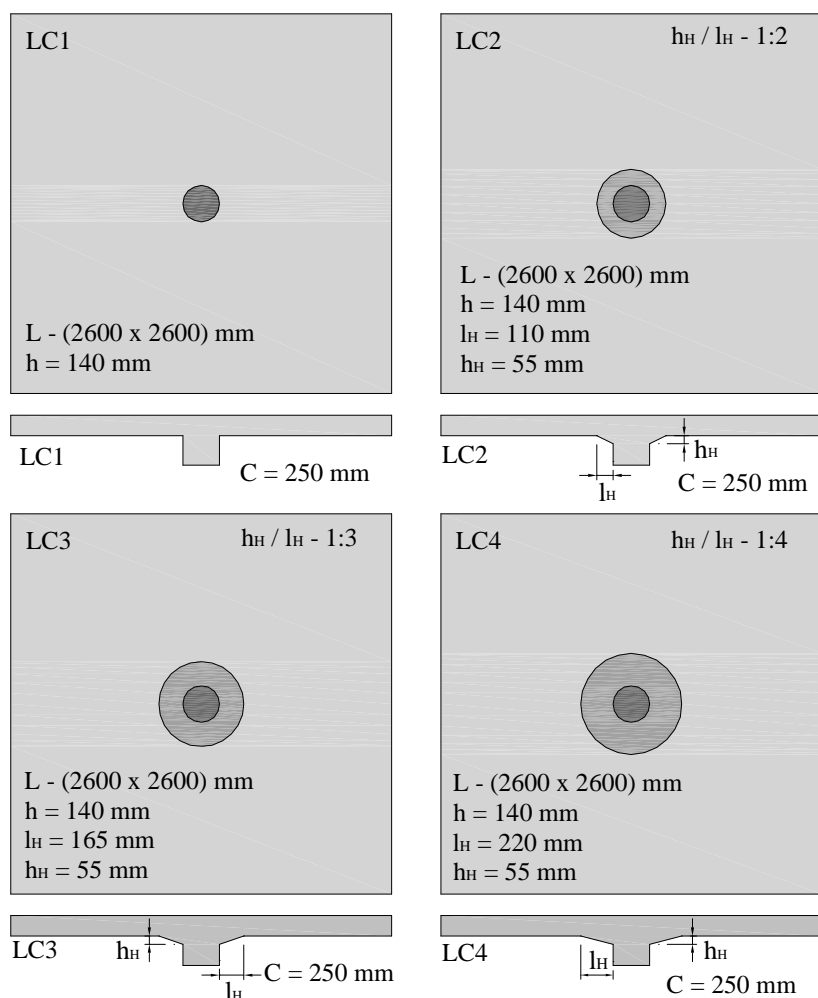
Lajes da primeira série de ensaios, com pilares de seção circular
